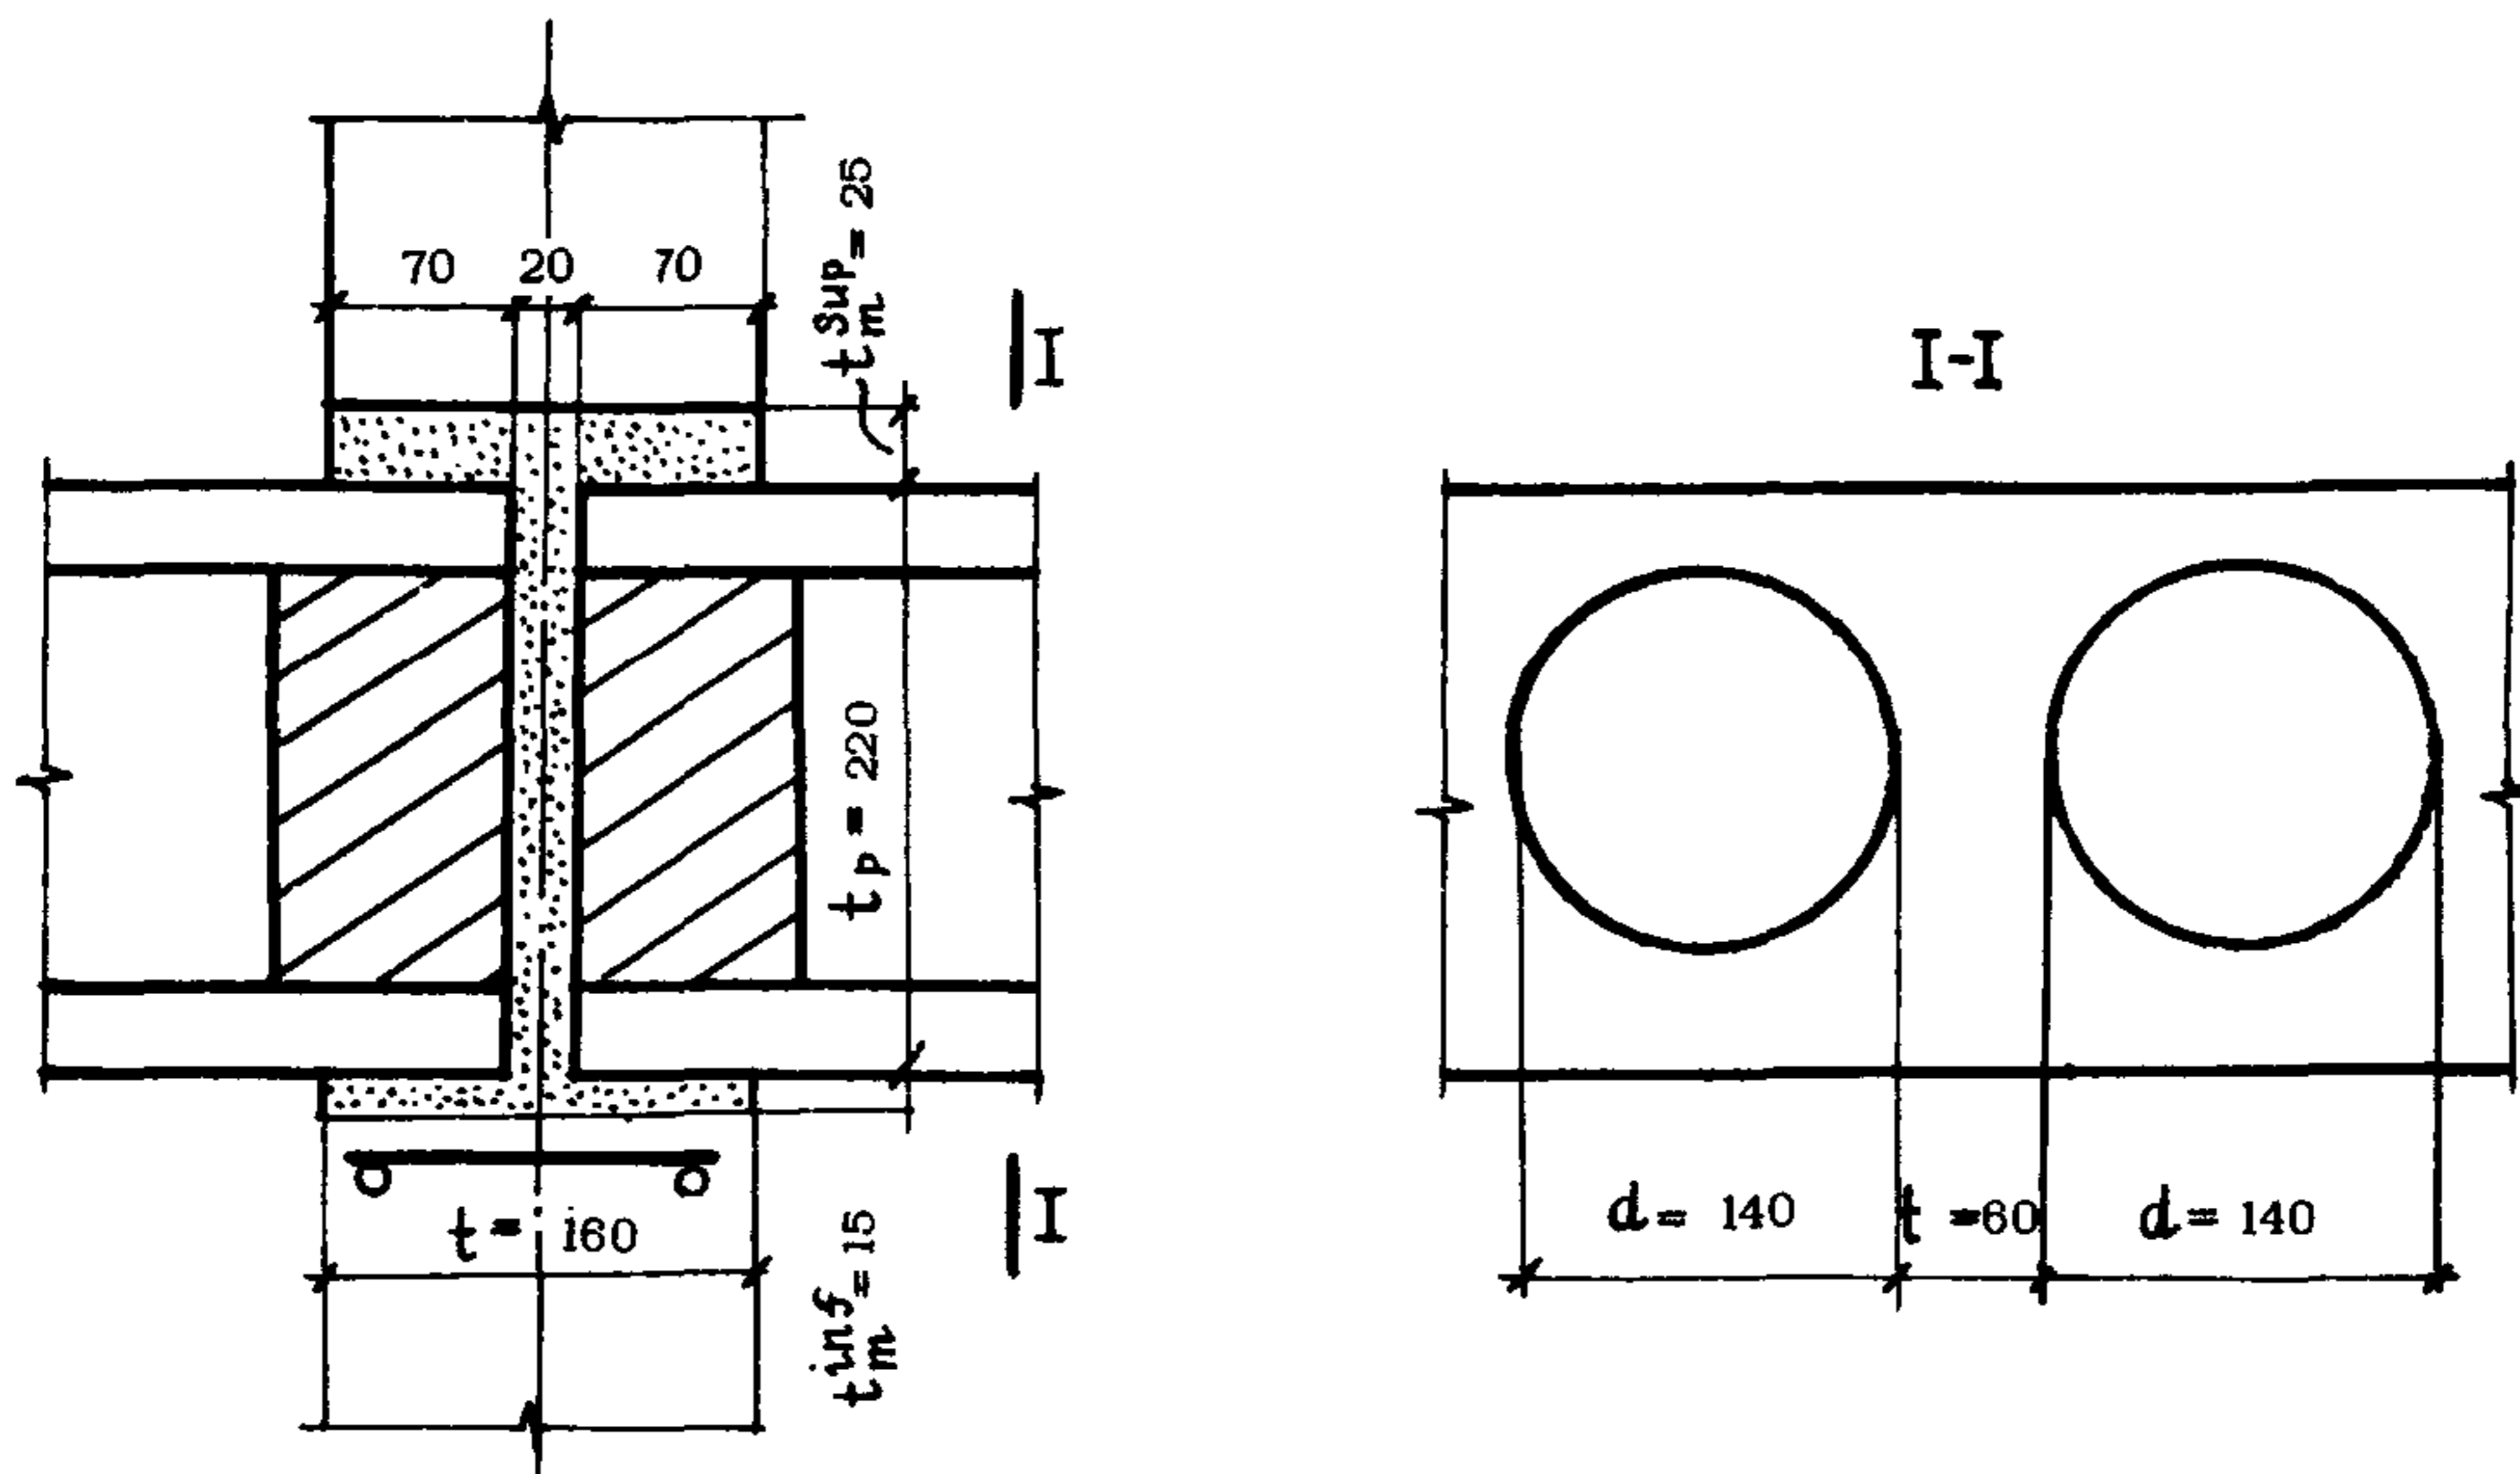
Платформенный стык внутренней панельной стены при двухстороннем опирании плит перекрытий (к примеру 1)
